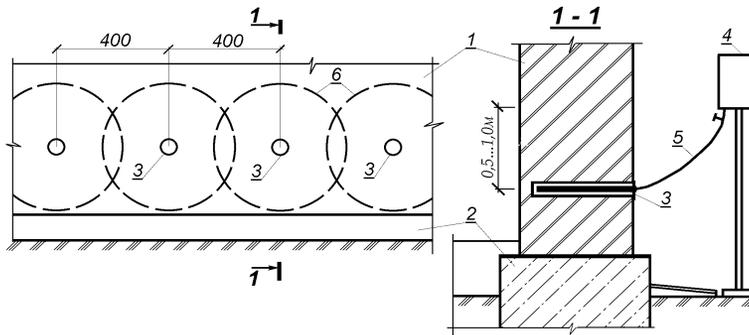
Гидроизоляция стен гидрофобными составами:
